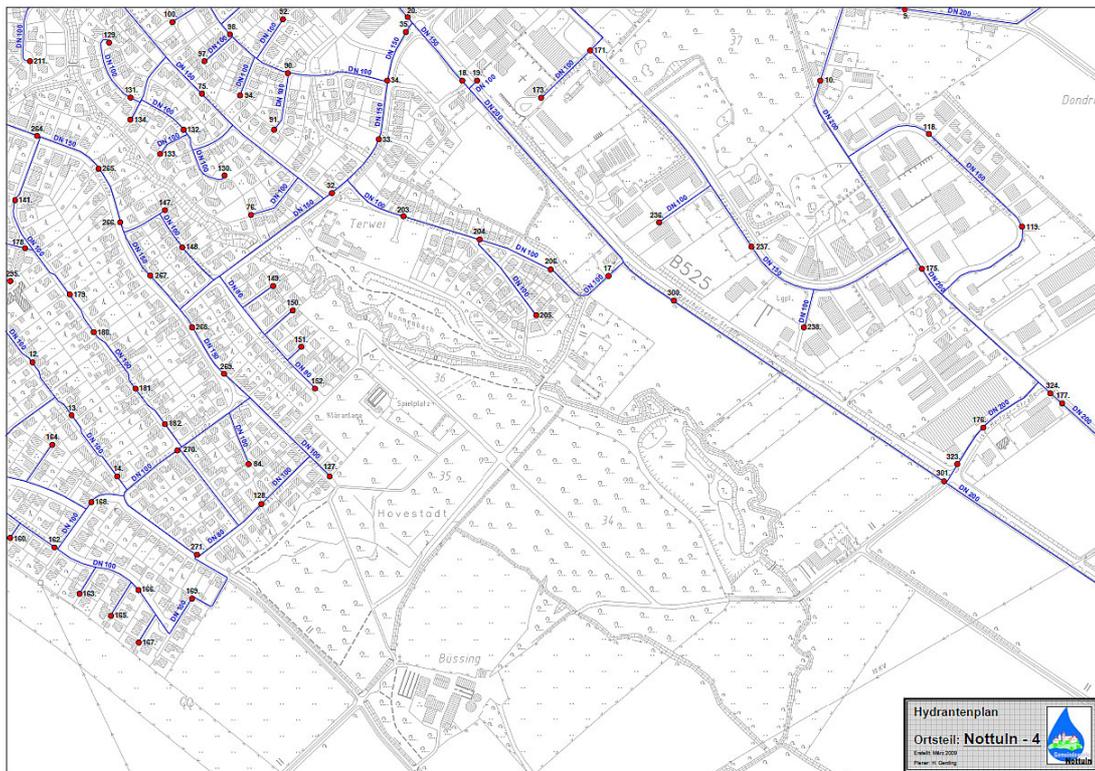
Trinkwasserversorgungsnetz mit Hydranten, Detailplan Nottuln Südost
